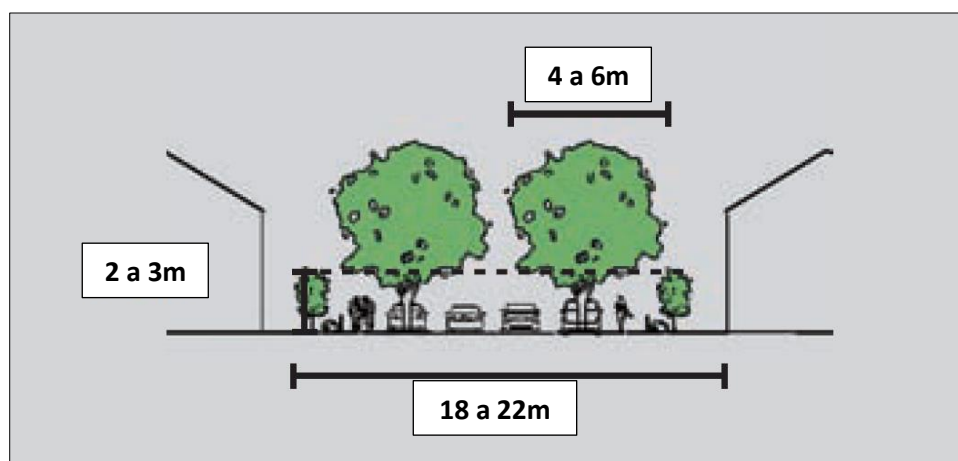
Tipología del perfil transversal de las calles terciarias.
